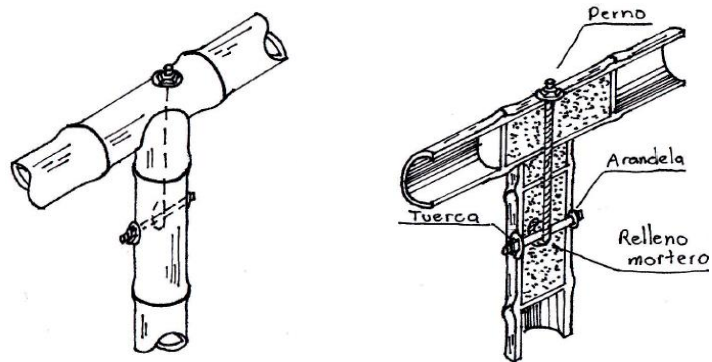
Detalle propuesto para la protección del elemento. Fuente:
